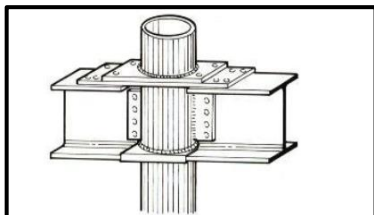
Assemblage poteau tubulaire/poutre tridimensionnelle (Source : Cours de 2eme année atelier de construction)
